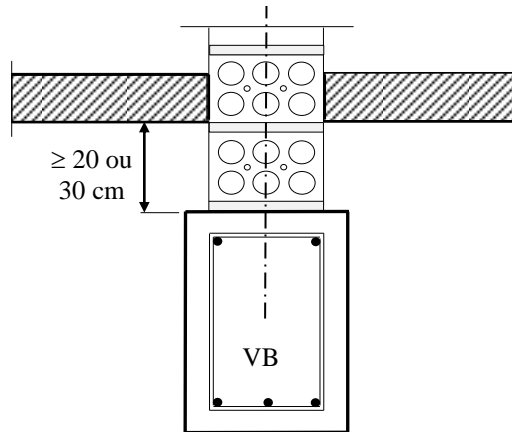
Altura livre entre a face superior da viga baldrame e o nível inferior do piso de concreto no caso de passagem das tubulações elétricas e hidráulicas acima das vigas baldrames.
